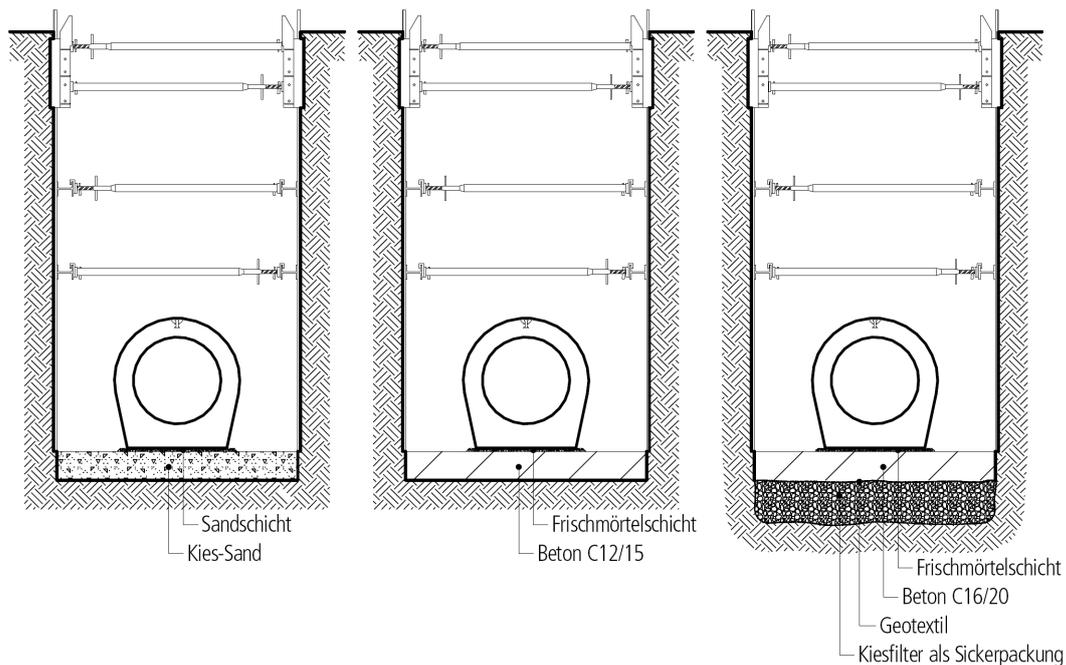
Möglicher Aufbau der Grabensohle mit Bettungstyp 1
